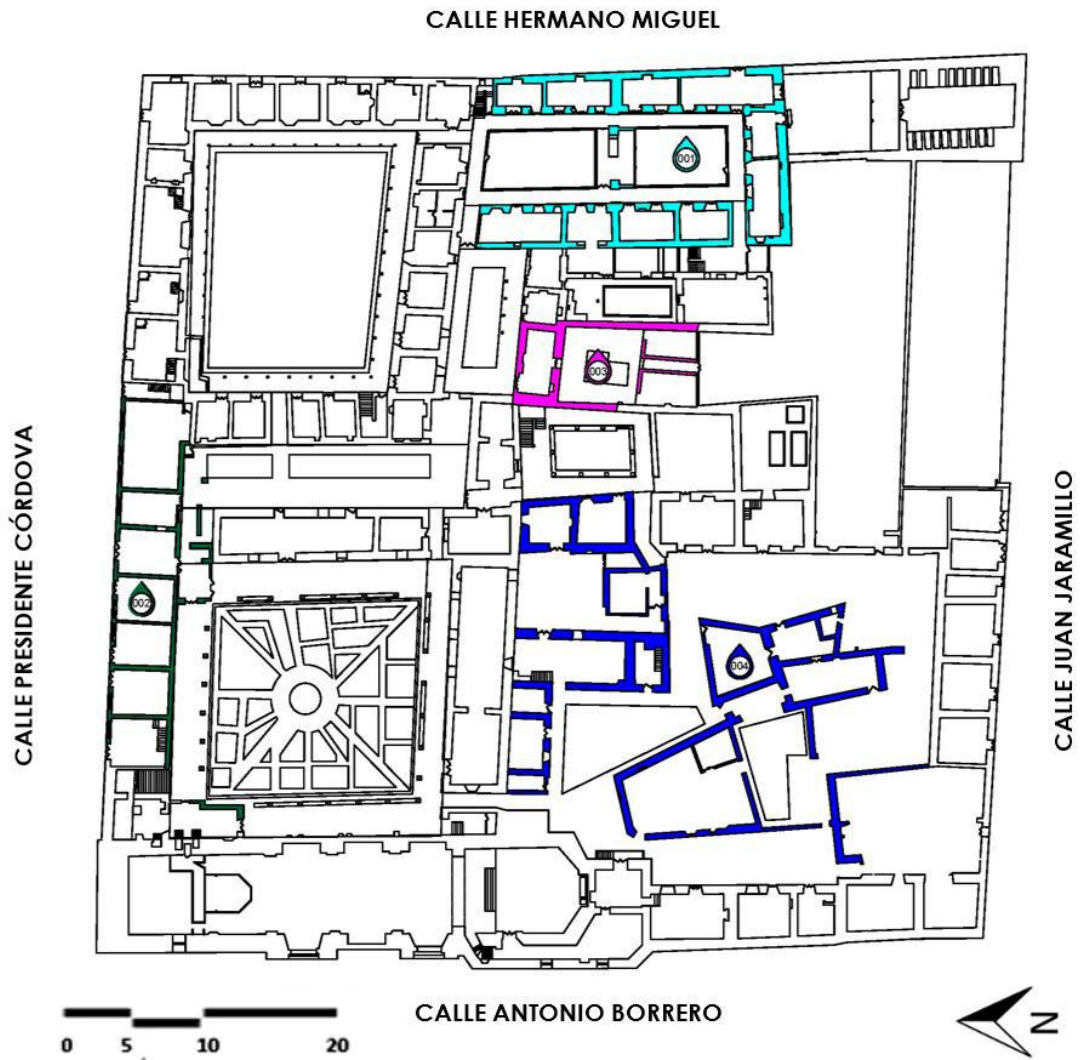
Plano Cronológico 1900 hasta la actualidad Planta Baja
